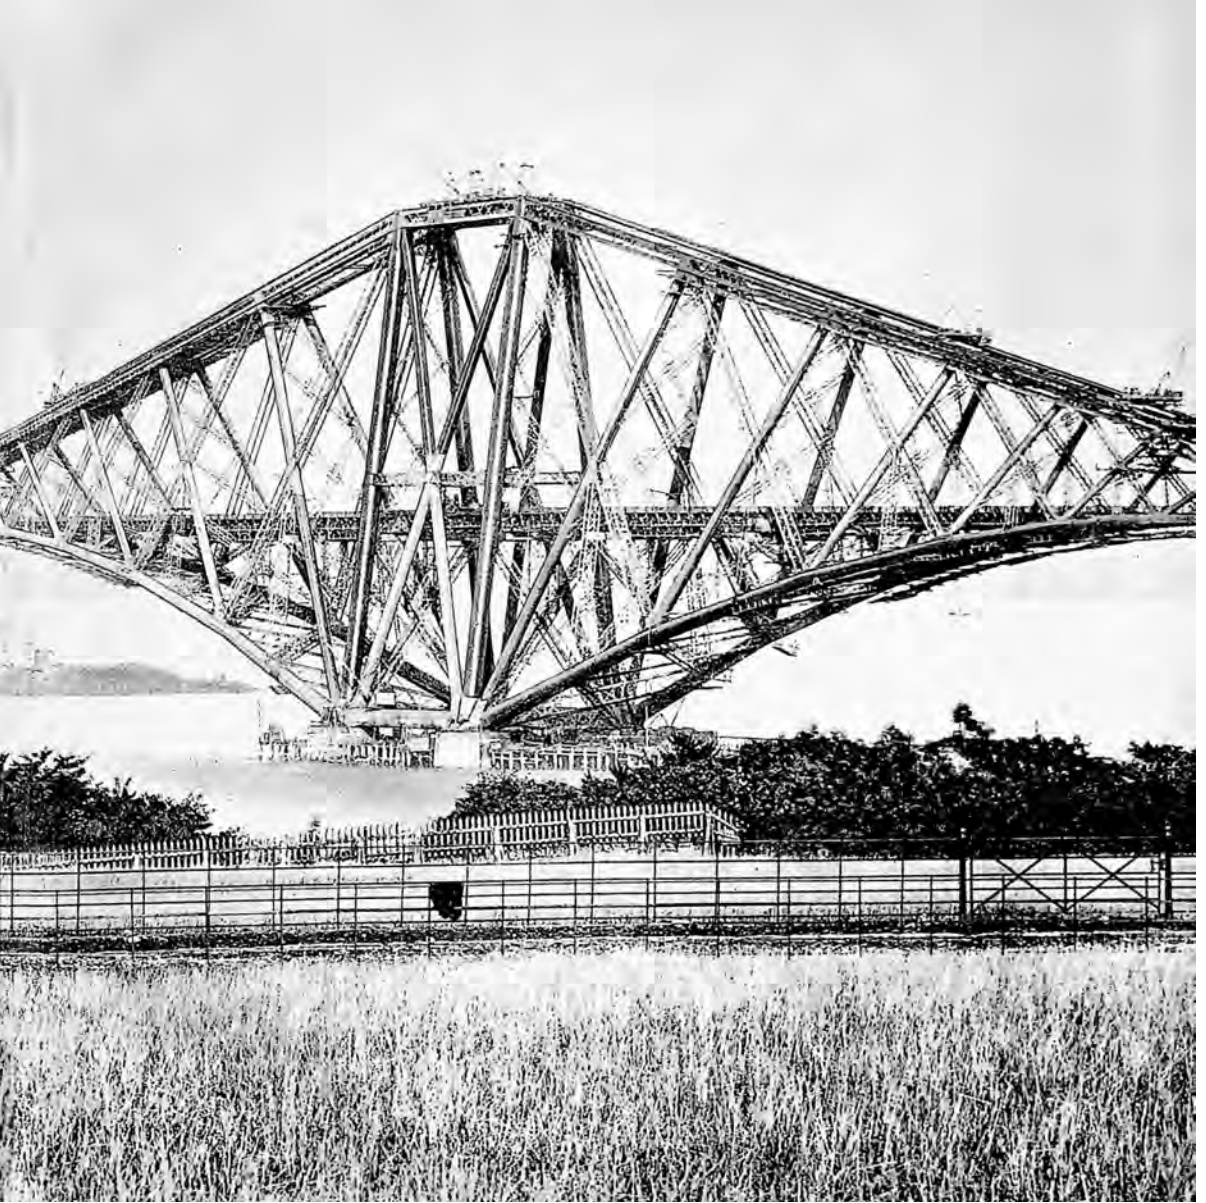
Le pont de la Forth (coord. : 56.00108N, 3.38864W). Tiré à part du journal *Engineering*, le 28 février 1890. La planche IV présente la vue générale du pont, la poutre centrale sud est reliée aux deux porte-à-faux ; la poutre centrale nord est encore inachevée (archives de famille).
